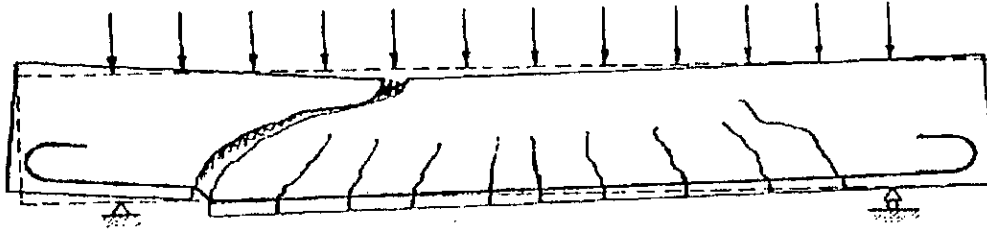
Fissuration lors de la rupture par cisaillement et compression.
